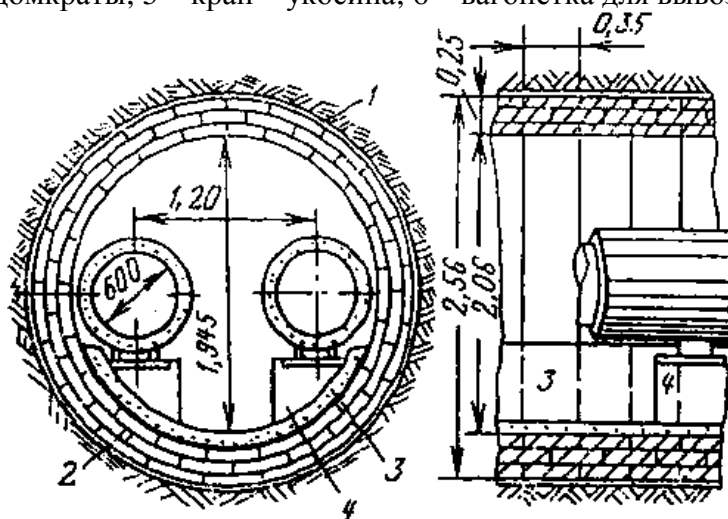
Канал из железобетонных колец при щитовой проходке.
